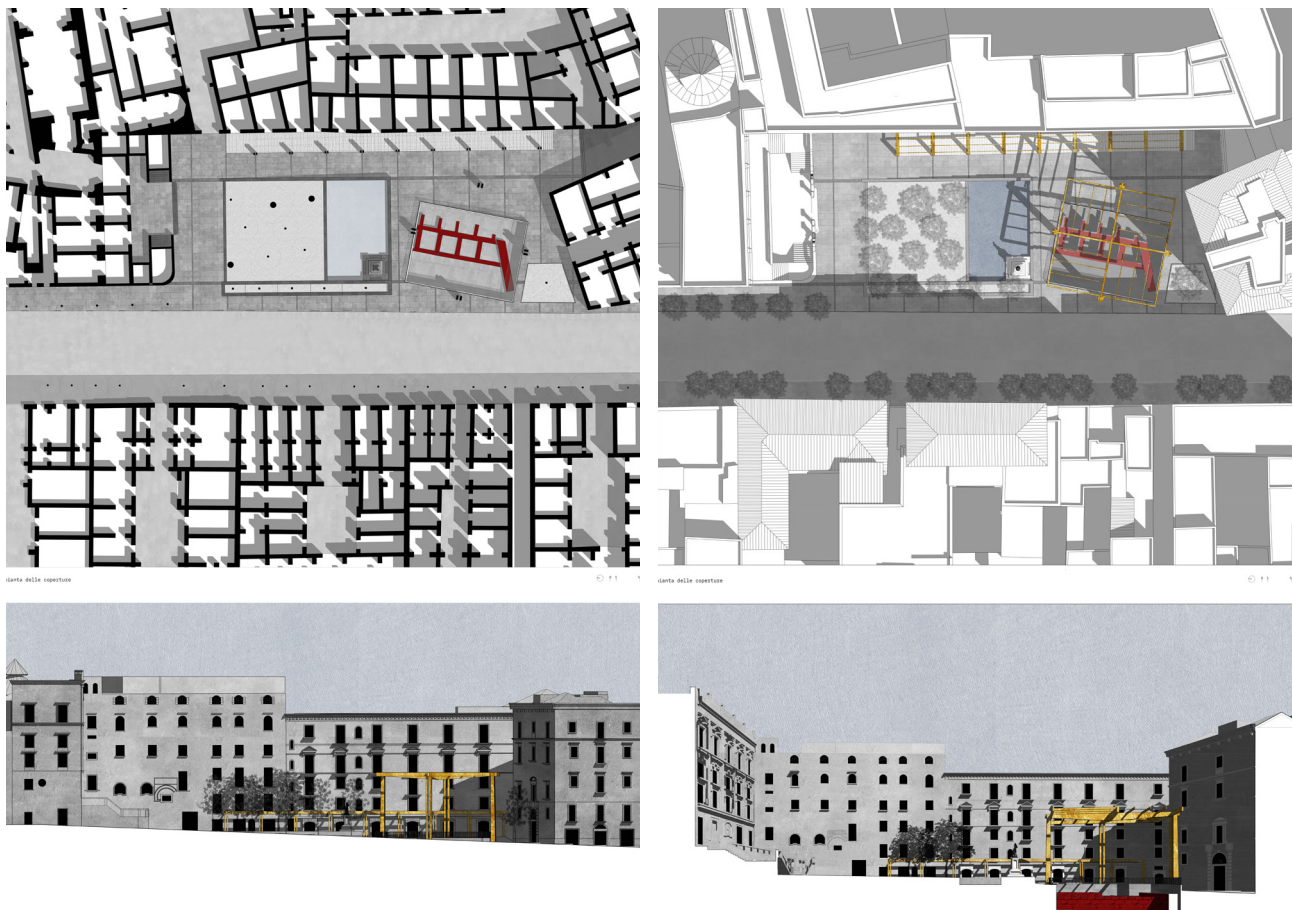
R. Capozzi e F. Visconti; con M. R. Alfano, A. Arena, F. Castiello e C. L. Cioffi, 2023: a. Pianta tipologica e profilo del progetto di copertura delle mura greche e sistemazione di Piazza Bellini; b. Pianta delle coperture e sezione prospettica sugli scavi del progetto di copertura delle mura greche e sistemazione di Piazza Bellini.
